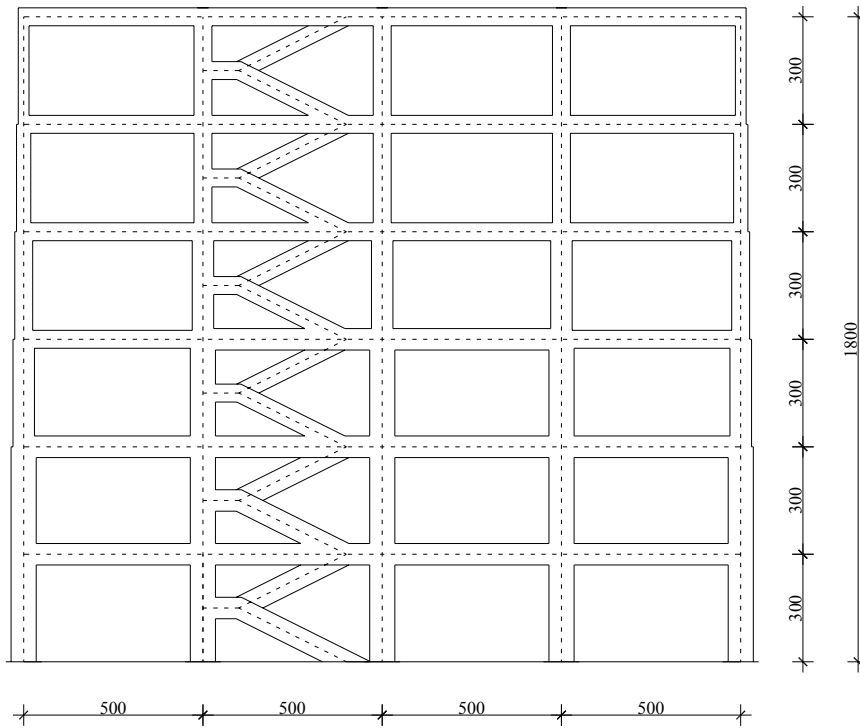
Prospetto struttura esaminata a 6 piani (misure in cm).
